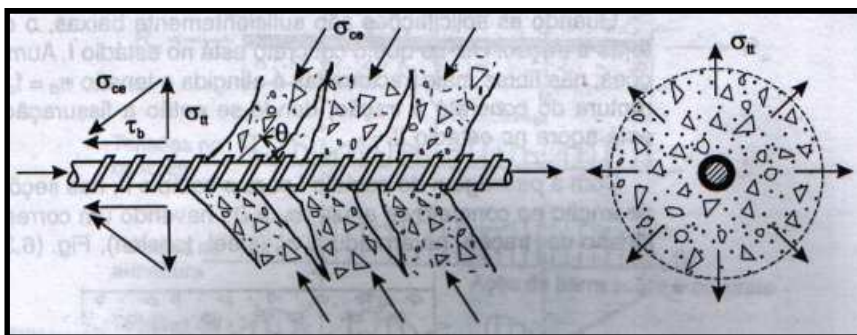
Zona de graute fissurada (Fusco, 1975)
